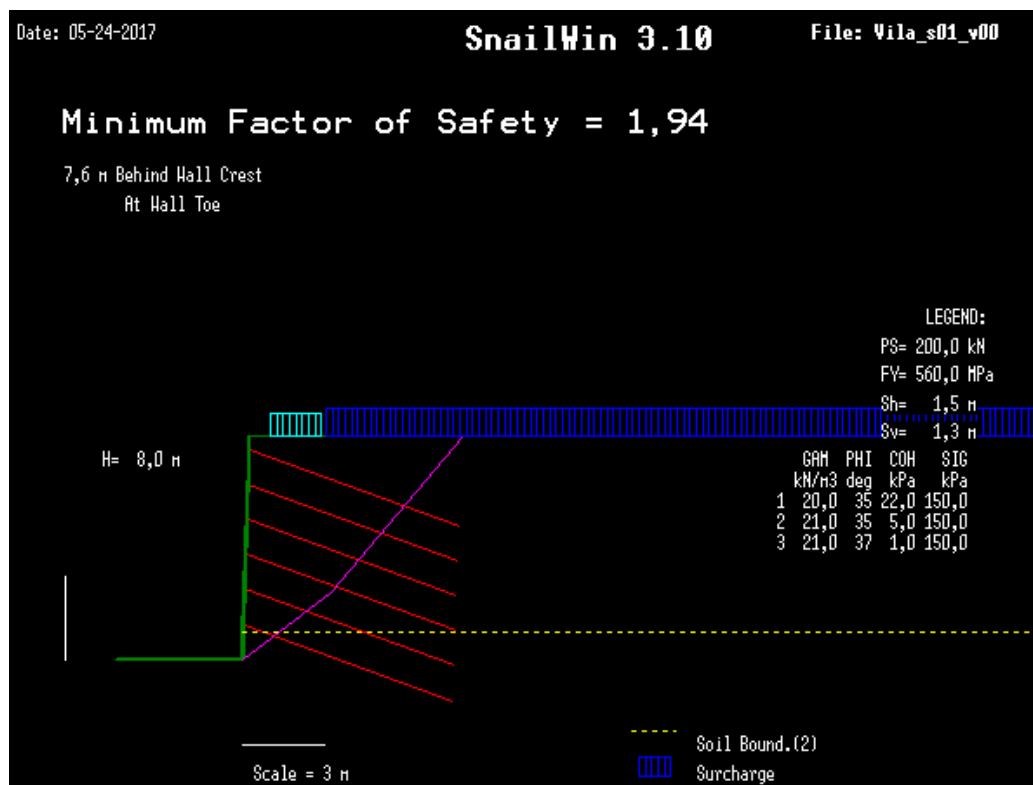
Sección 2 de cálculo con el software SNAILZ.
